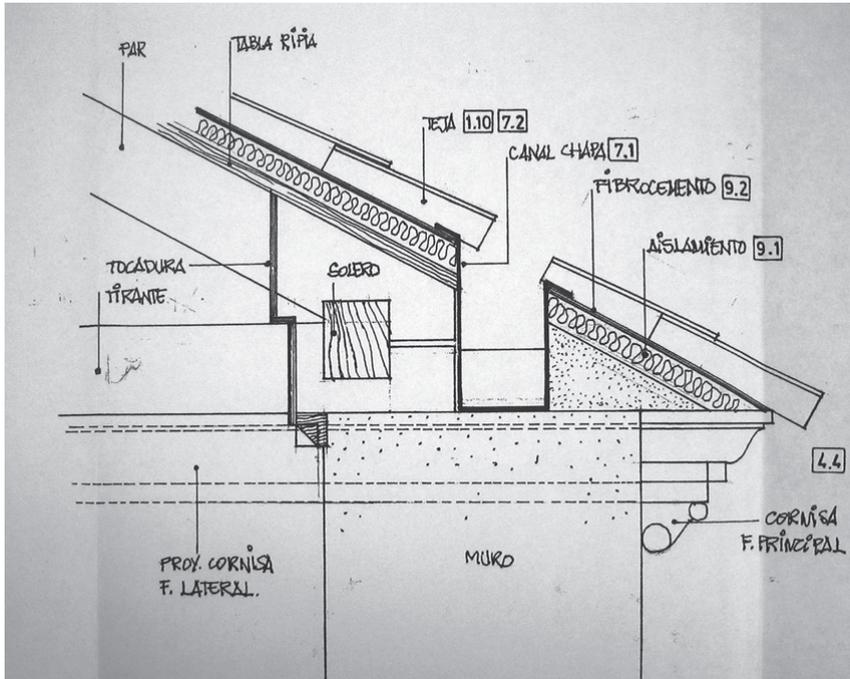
Detalle constructivo de la solución de cubierta. 2001. Berges Roldán
